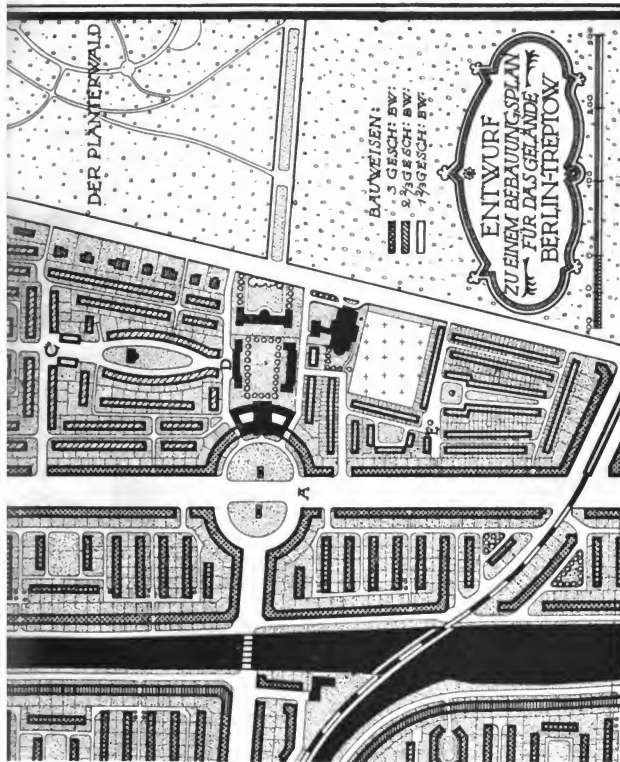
Bebauungsplan für Berlin-Treptow. Entf.
